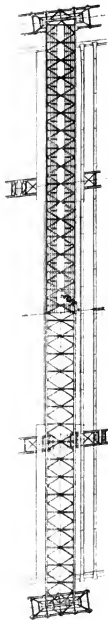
Grundriss der Aufstellungsbauwerke.
